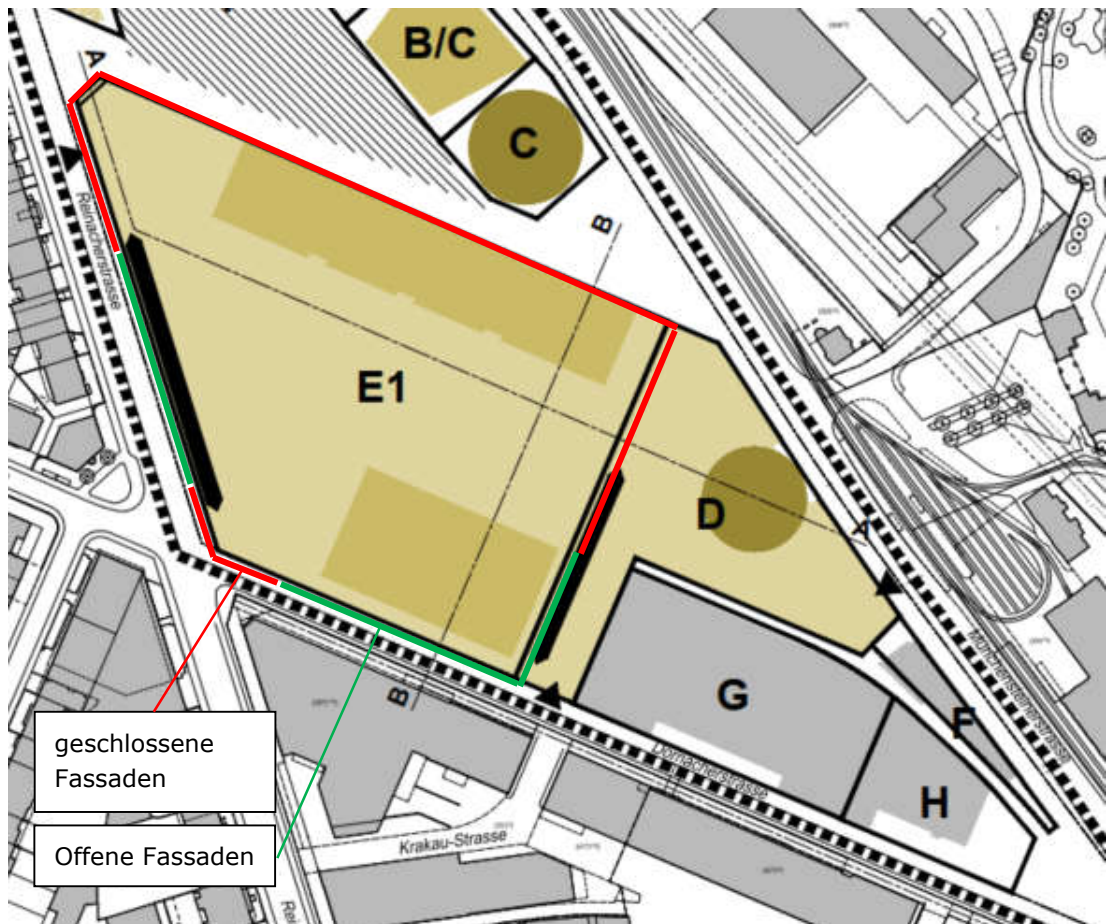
Grundriss 2. Obergeschoss Parking Migros [Bebauungsplan Situation Erdgeschoss, Stand 18.11.2020]
